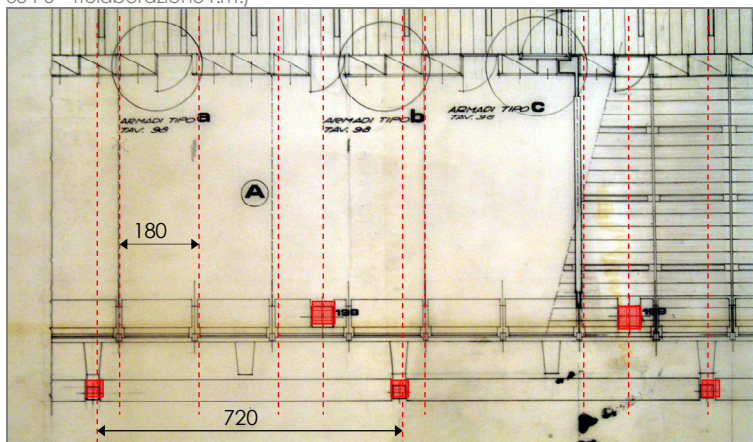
stralcio piano tipo (fonte CSAC – stralcio tav. 55 bis, archivio n. 384-5 – rielaborazione f.m.)
